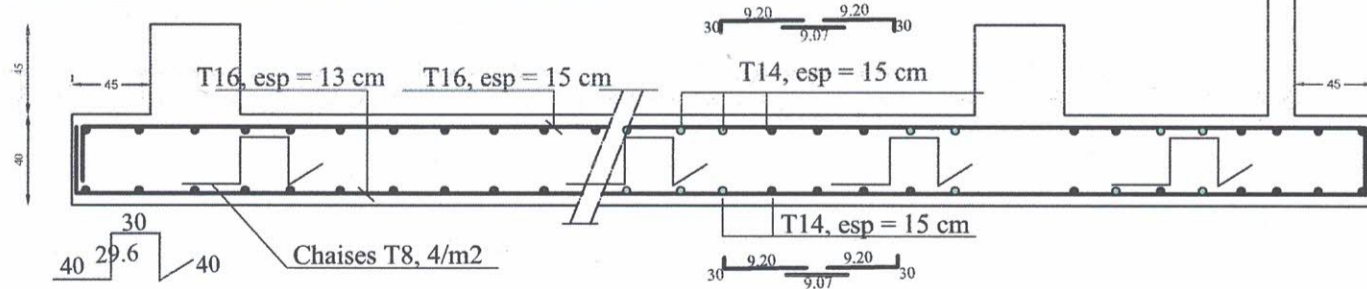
DETAIL SUR FERRAILLAGE NERVURES AUX APPUIS SENS XX et YY
